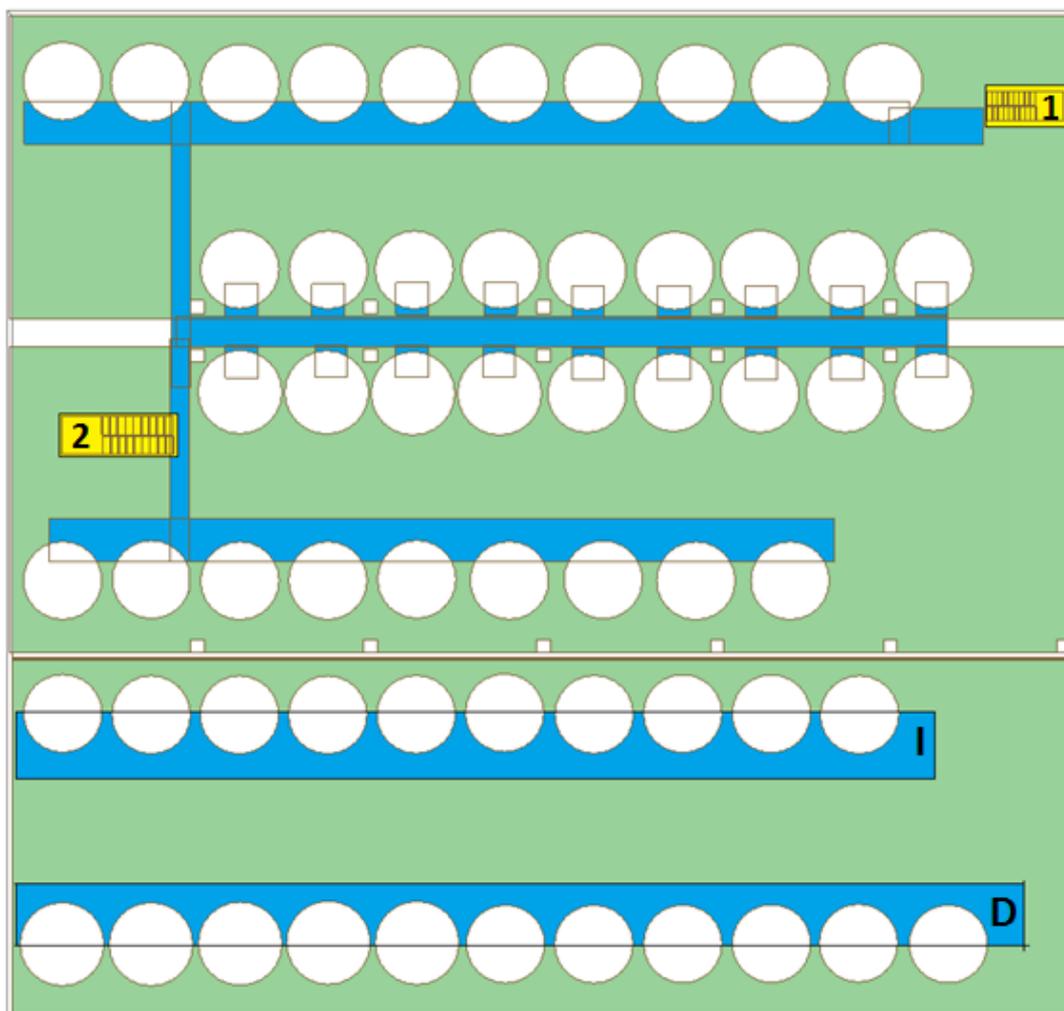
Vista en planta del almacén. Fuente: DIALux
